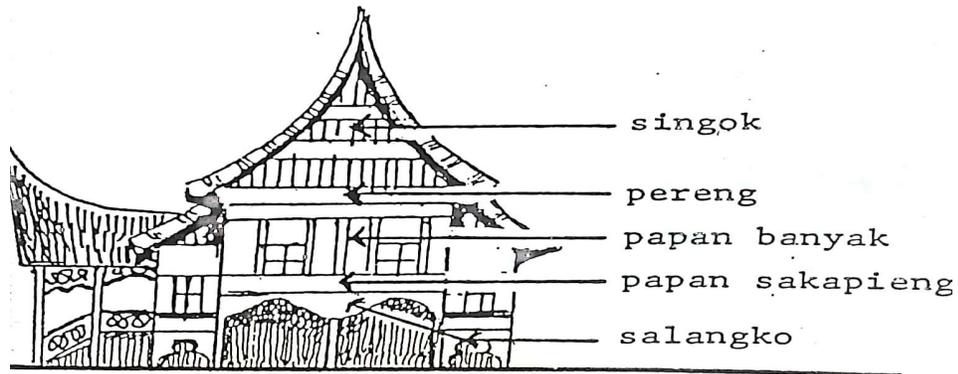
Bentuk bangunan tampak depan PDIKM Kota Padangpanjang (Foto: Prastawa, 2021)
